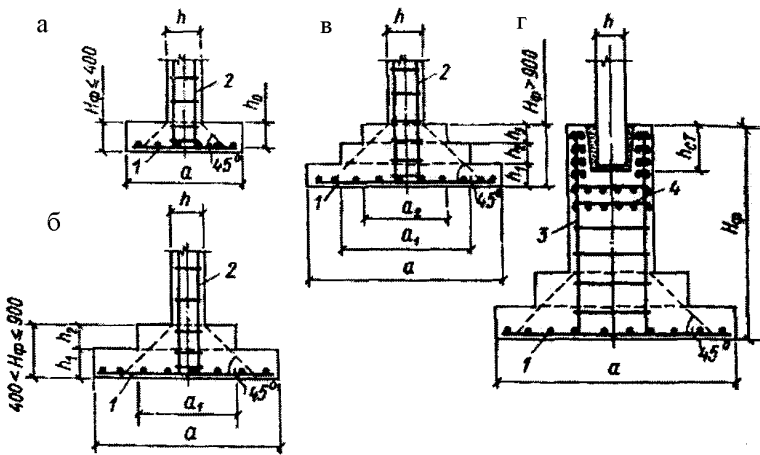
Монолітні залізобетонні фундаменти:
